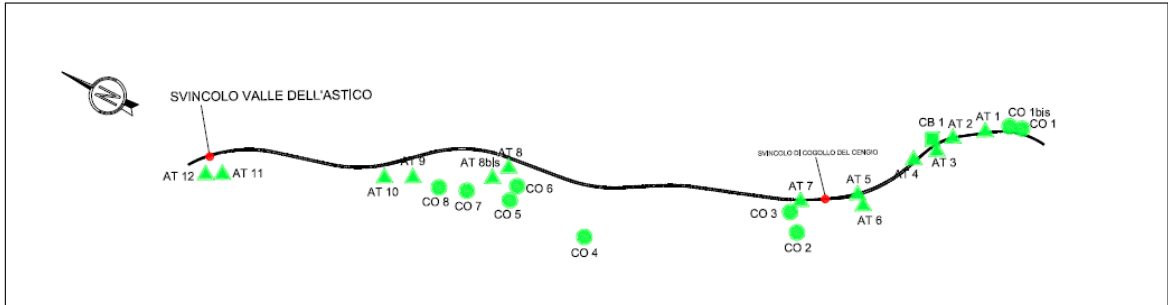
keyplan con individuazione delle aree di cantiere lungo il tracciato
